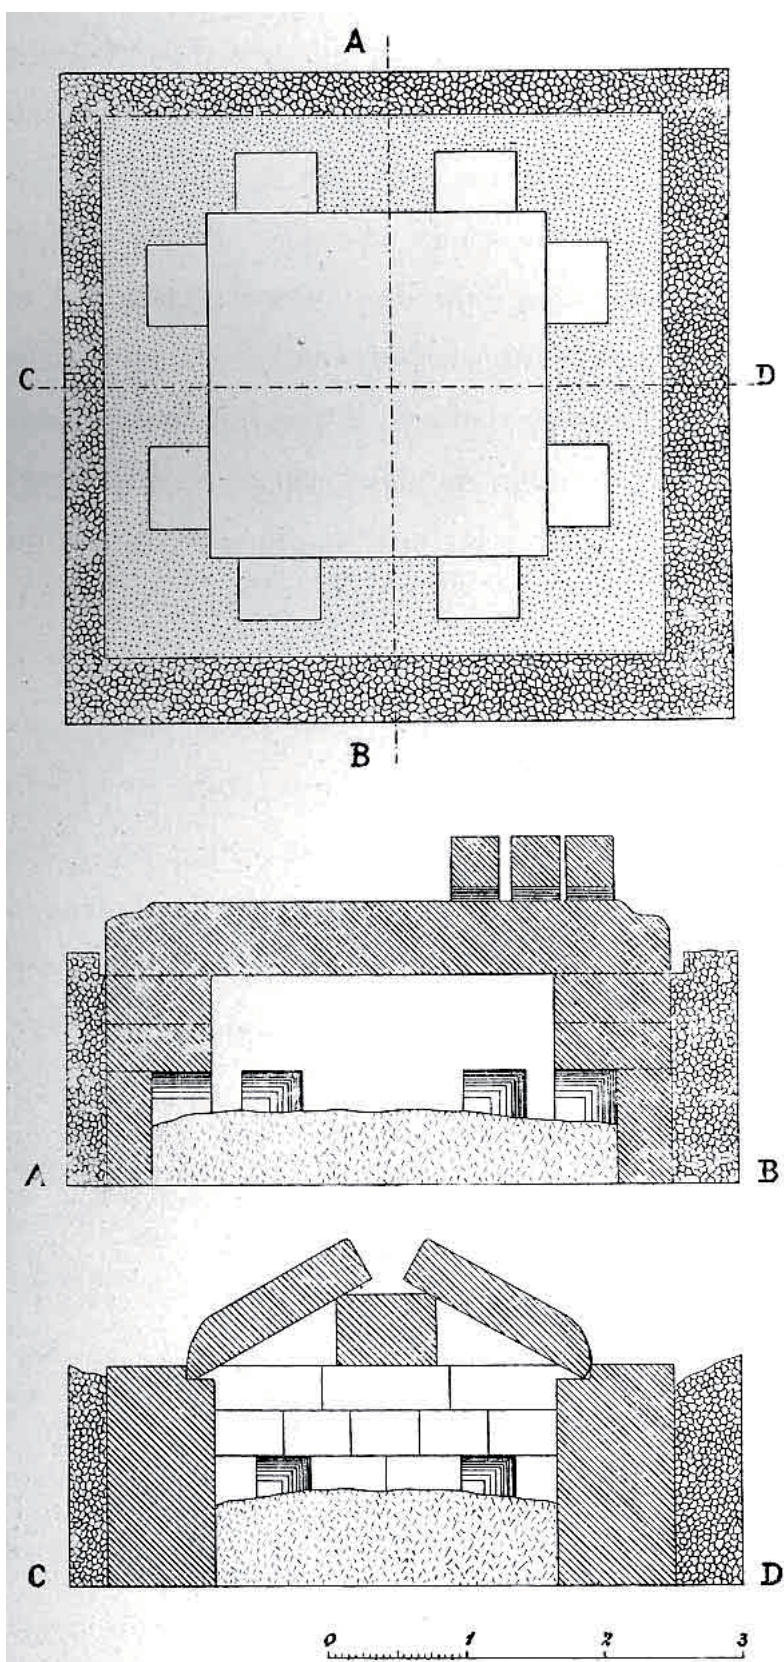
Plan et coupes d'un caveau de Sigus.
